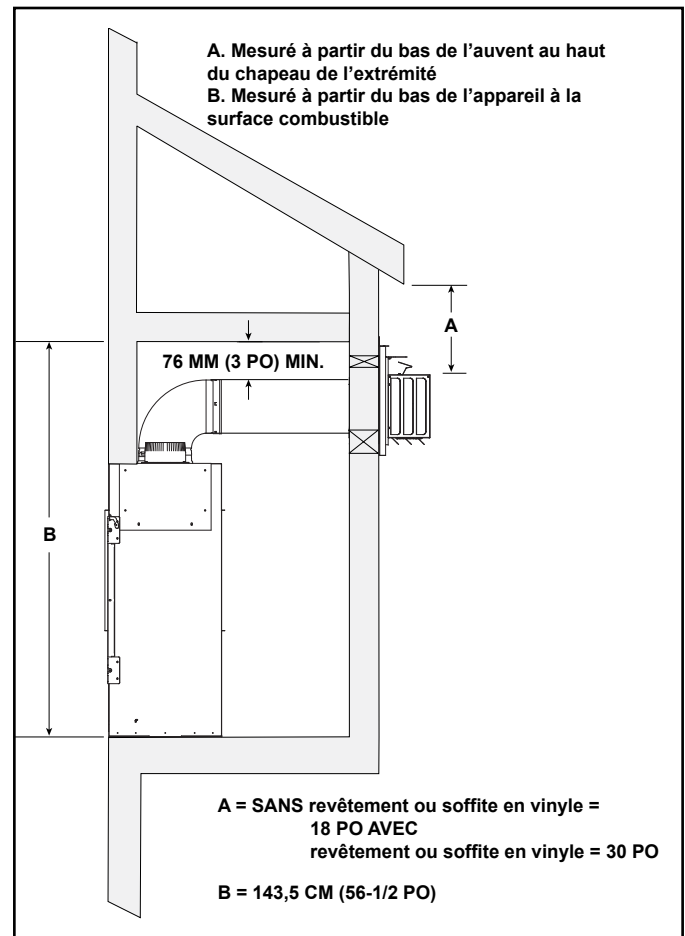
Enchâssure extérieure – Exigences minimales de hauteur
